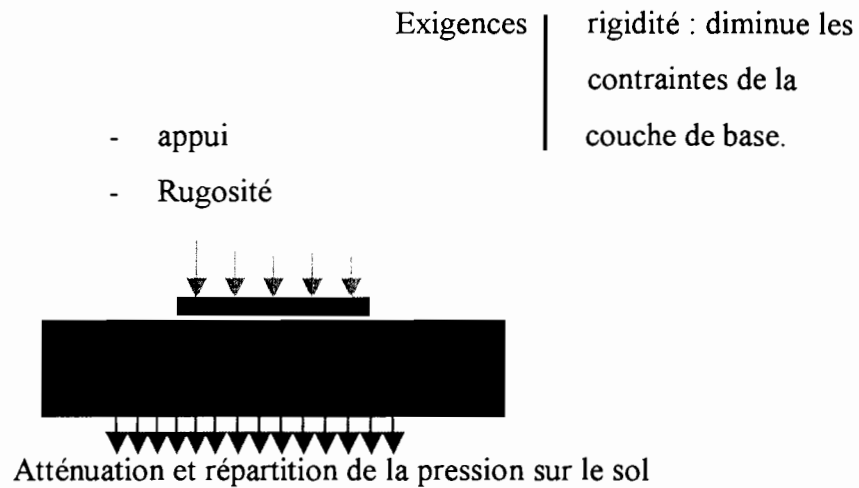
Principales exigences auxquelles doit répondre une couche de fondation
